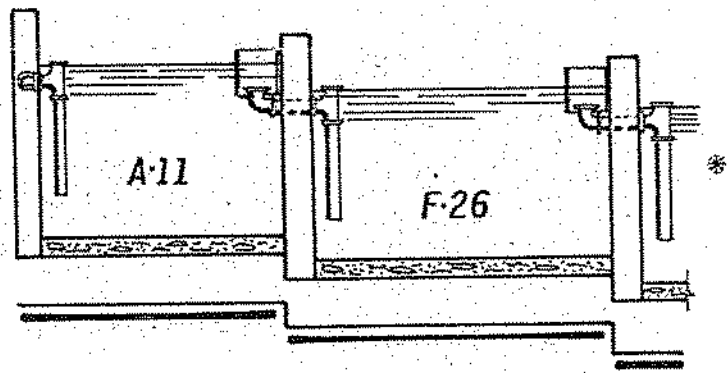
PLANTA DE LOCAÇÃO ONDE ESTAVAM AS INSTALAÇÕES DO SISTEMA DE LAGOAS EM SÉRIE PESQUISADAS
